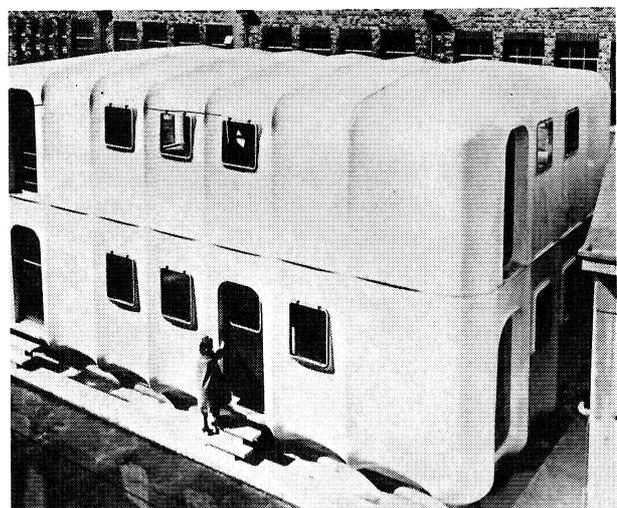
Mickleover de Londres: Estructura de dos plantas a base de plástico reforzado, Birmingham, 1963.
